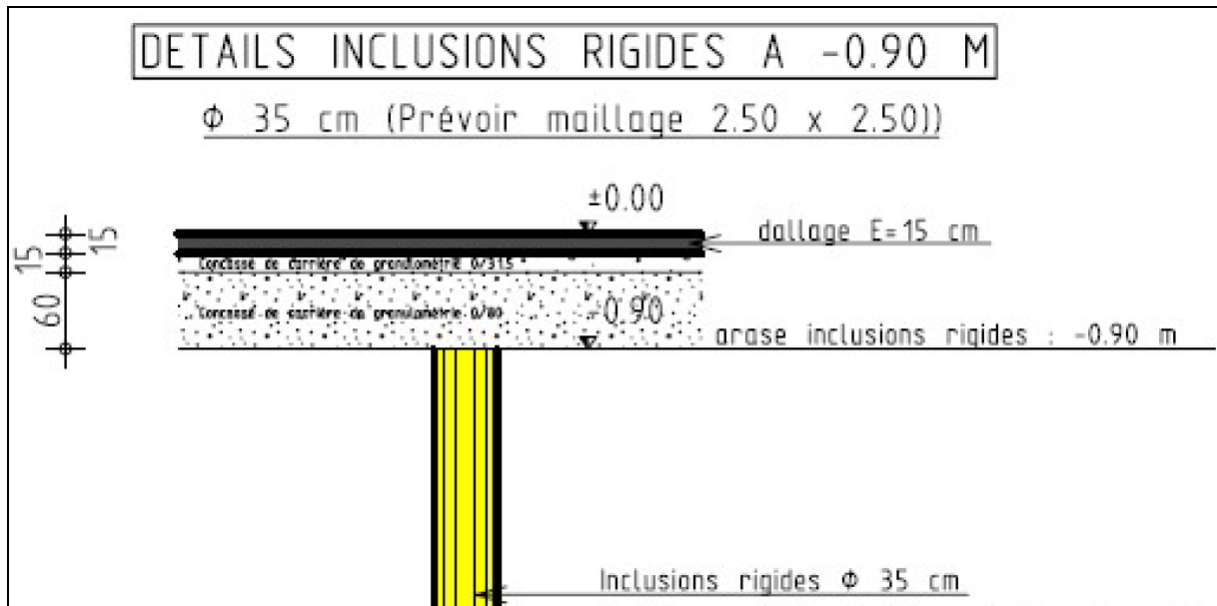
Coupe technique des fondations des nouveaux bâtiments
